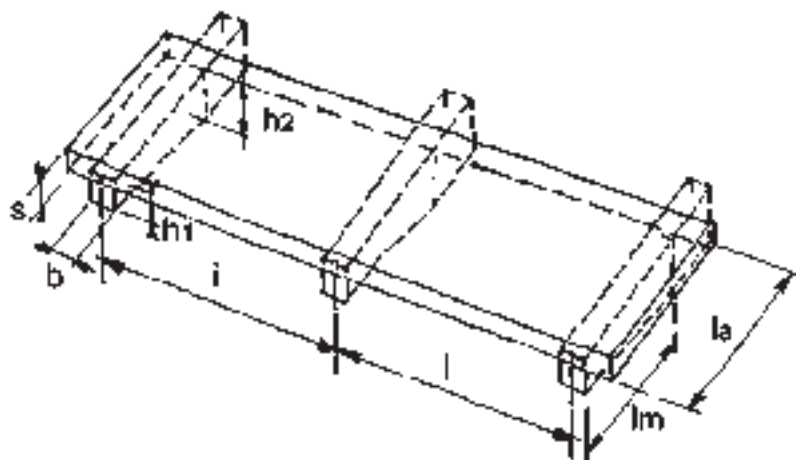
1 - Schema di un balcone formato da lastre su mensole incastrate sul muro di facciata.
